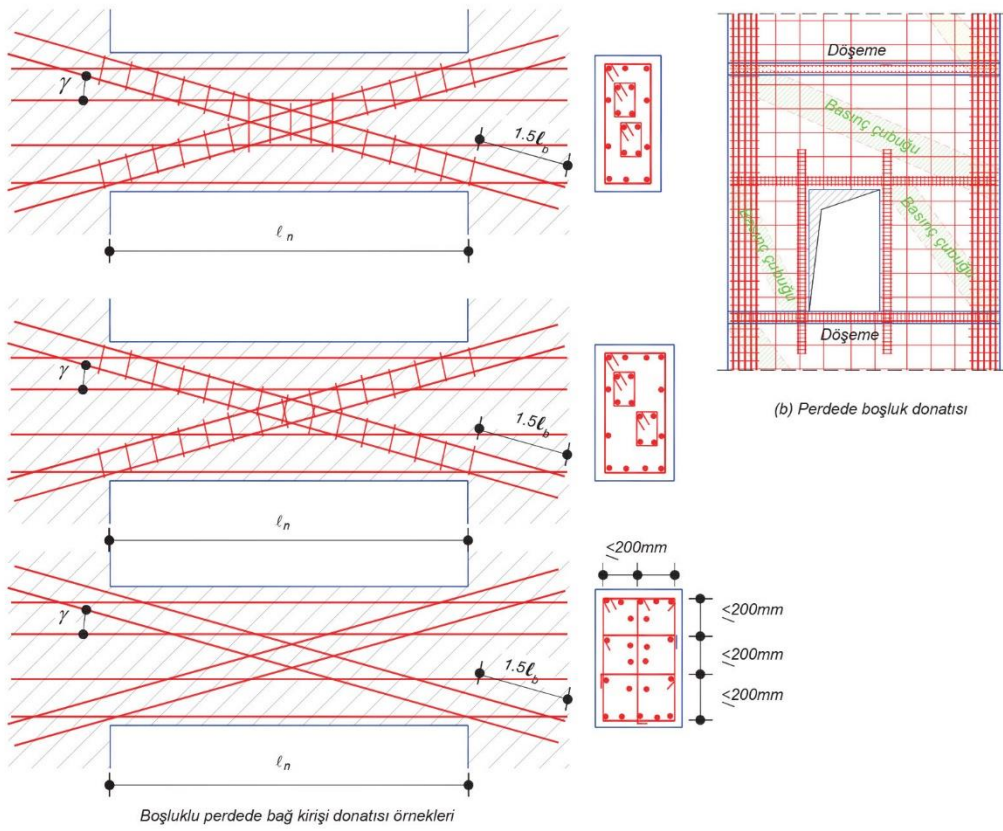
Betonarme Perde Çizim ve Detayları [25]
